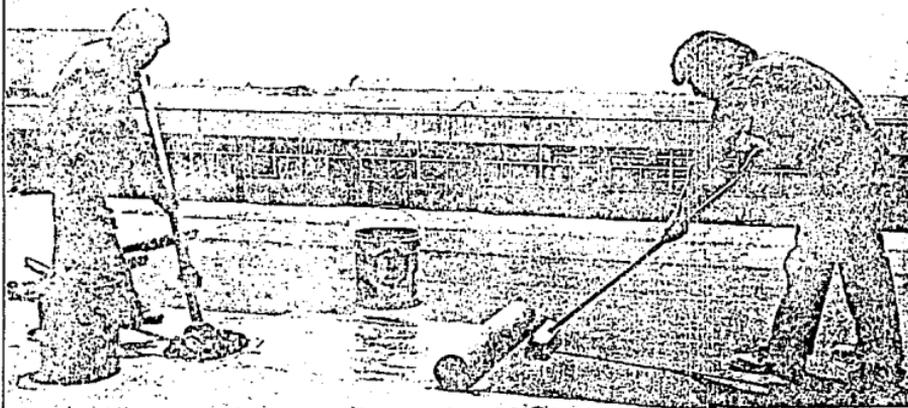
(a) Impermeabilizante asfáltico de aplicación en frío
